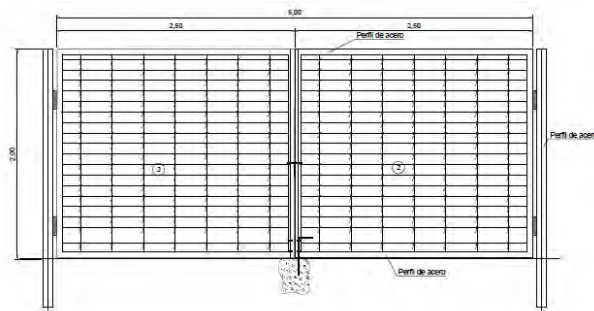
Detalle puerta de acceso a Planta Fotovoltaica
